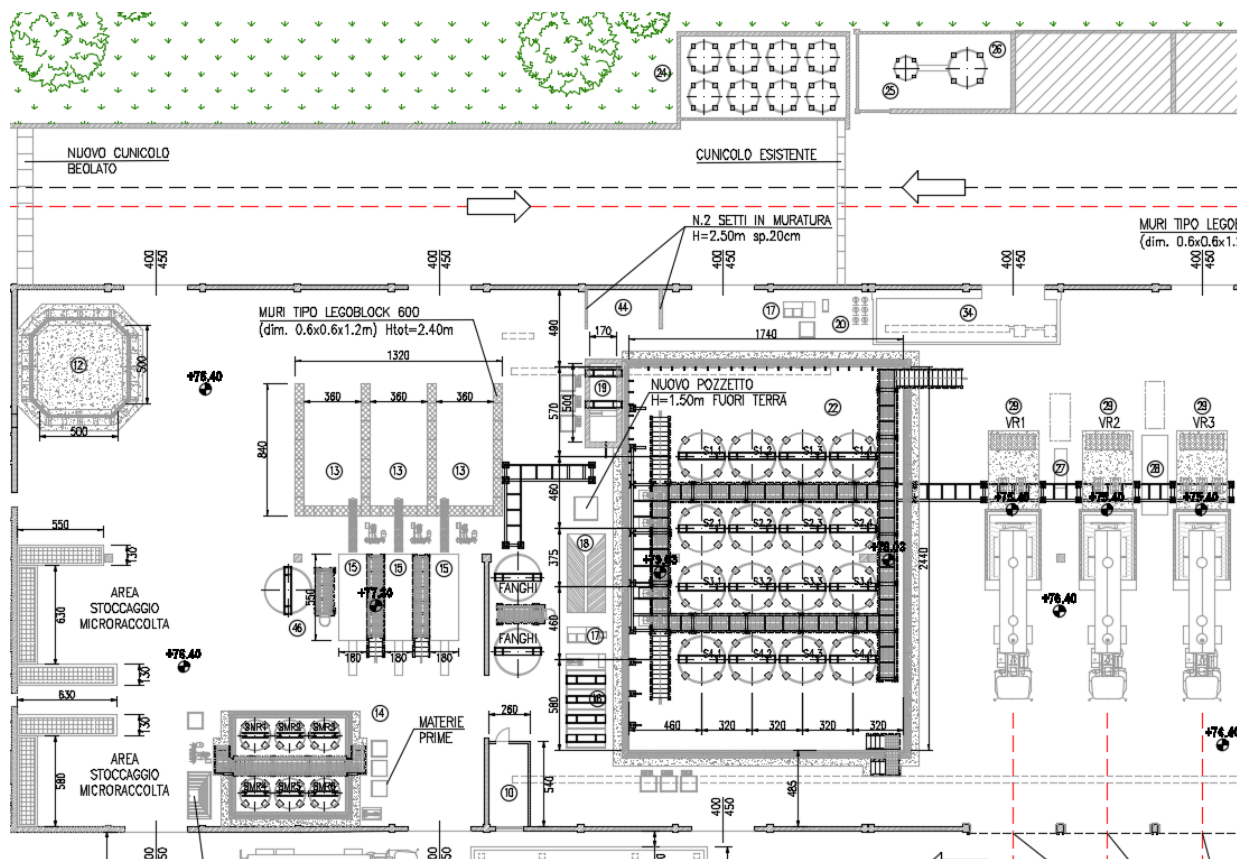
vista planimetrica impianto trattamento chimico/fisico
